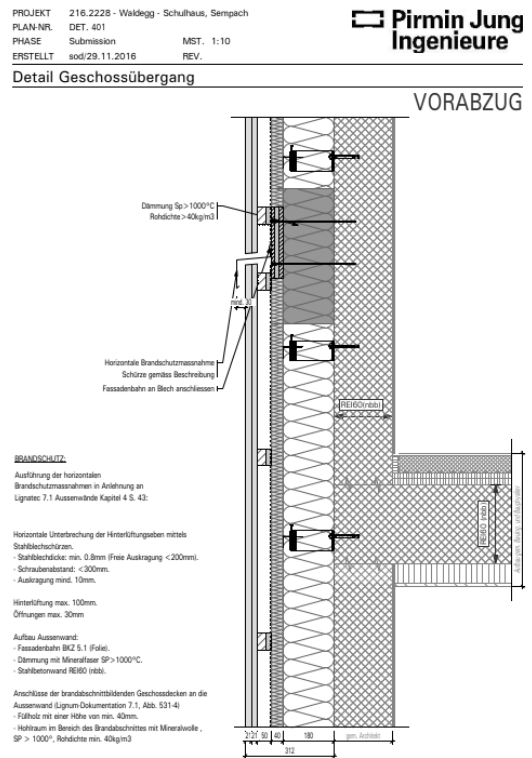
Musterdetail einer Holzfassade - Stand Erstellung Leistungsverzeichnis.
